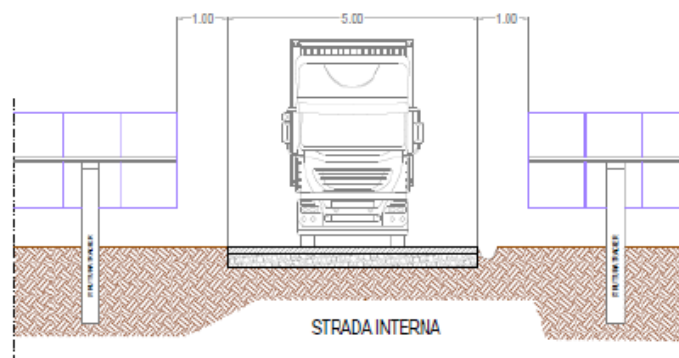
Tipologico sezione stradale viabilità d'impianto.
